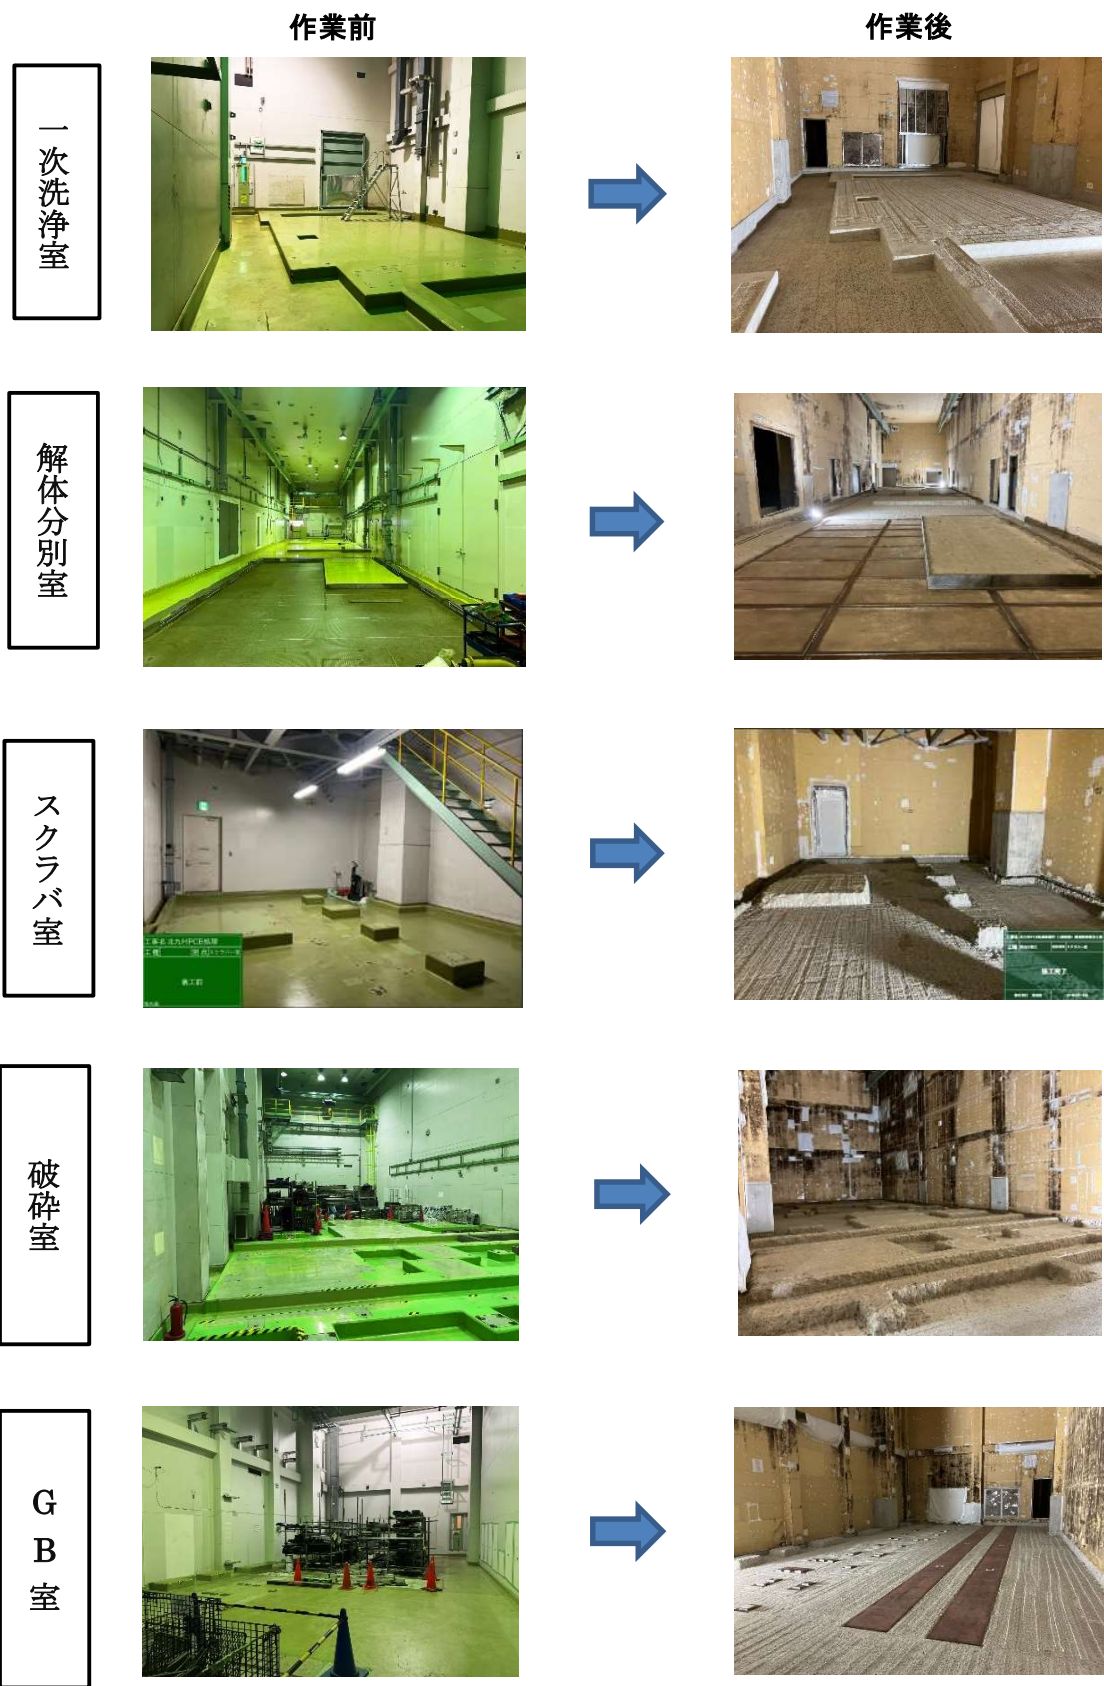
PCB 除去分別作業前後の状況（次頁に続く）
